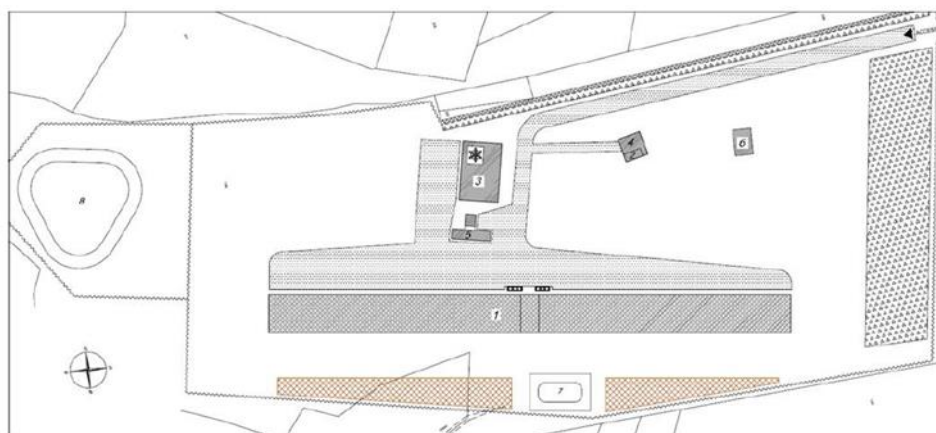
Planimetria allevamento avicolo Chiareto – Bellante (TE)
